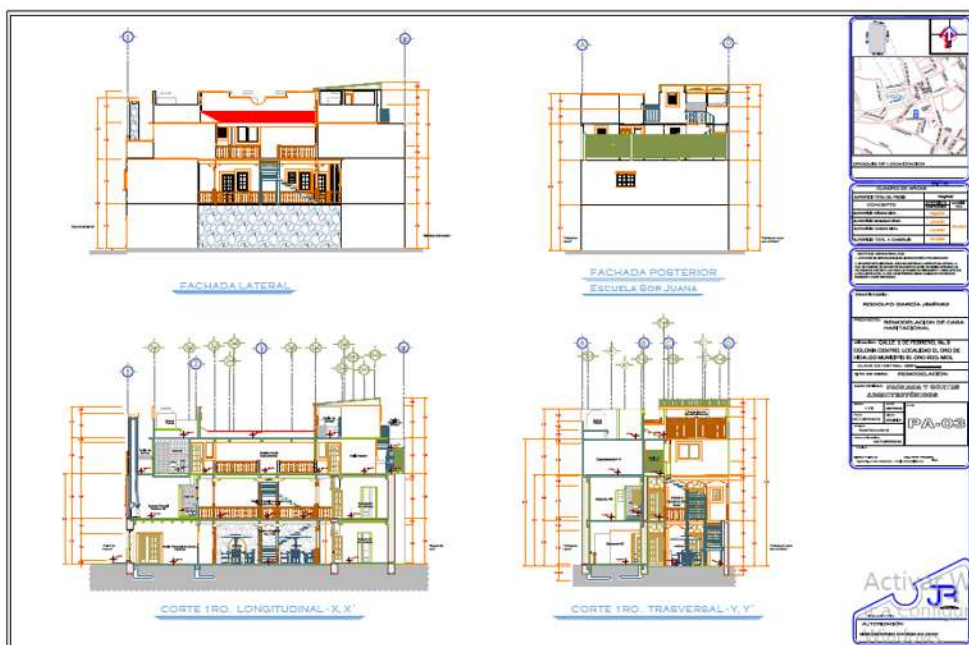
Imagen del Tercer Plano Arquitectónico, donde se representa la fachada posterior, la cual se visualizara de lado de la Escuela central “Sor Juan Inés de la Cruz” y la fachada lateral, en donde se resalta la vista del patio central interior con sus barandales y las escaleras principal. También se considera la representación de secciones o cortes donde se destaca la sección longitudinal y sección transversal; en ellos se puede observar los niveles, los cortes de muros como de lozas y posibles trabes de cerramiento como de desplante. Otros elementos que destacan en la secciones, es la chimenea en corte como la charola de losa de baño. Por último se desea destacar el patio central; ya que a través de este plano se puede visualizar lo que el visitante observar al pasar por los pasillos que determinan la circulación de las habitaciones y vistas del interior del conjunto.
